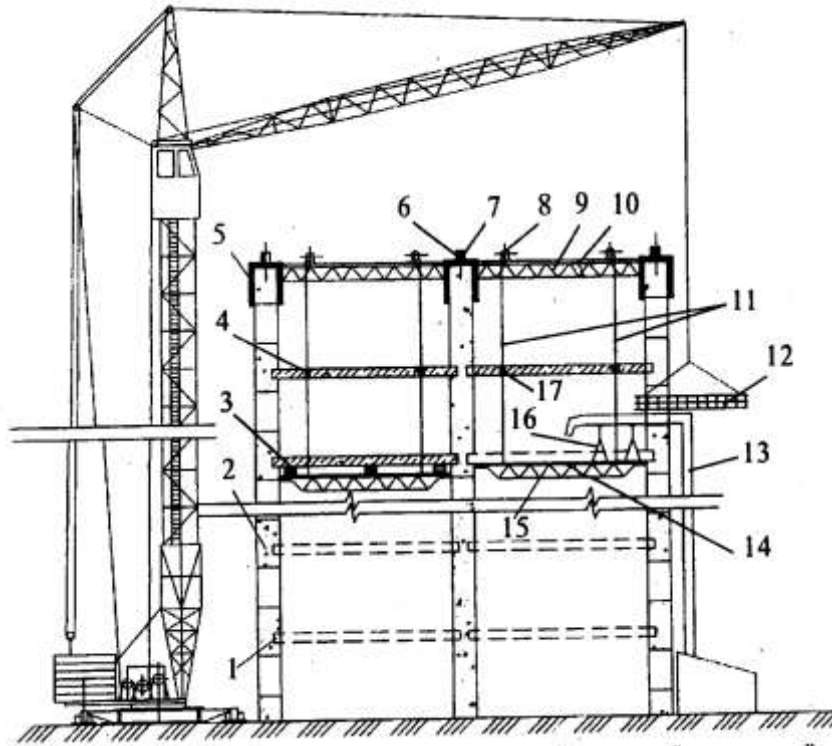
Бетонування міжповерхових перекриттів методом «зверху до низу»:
